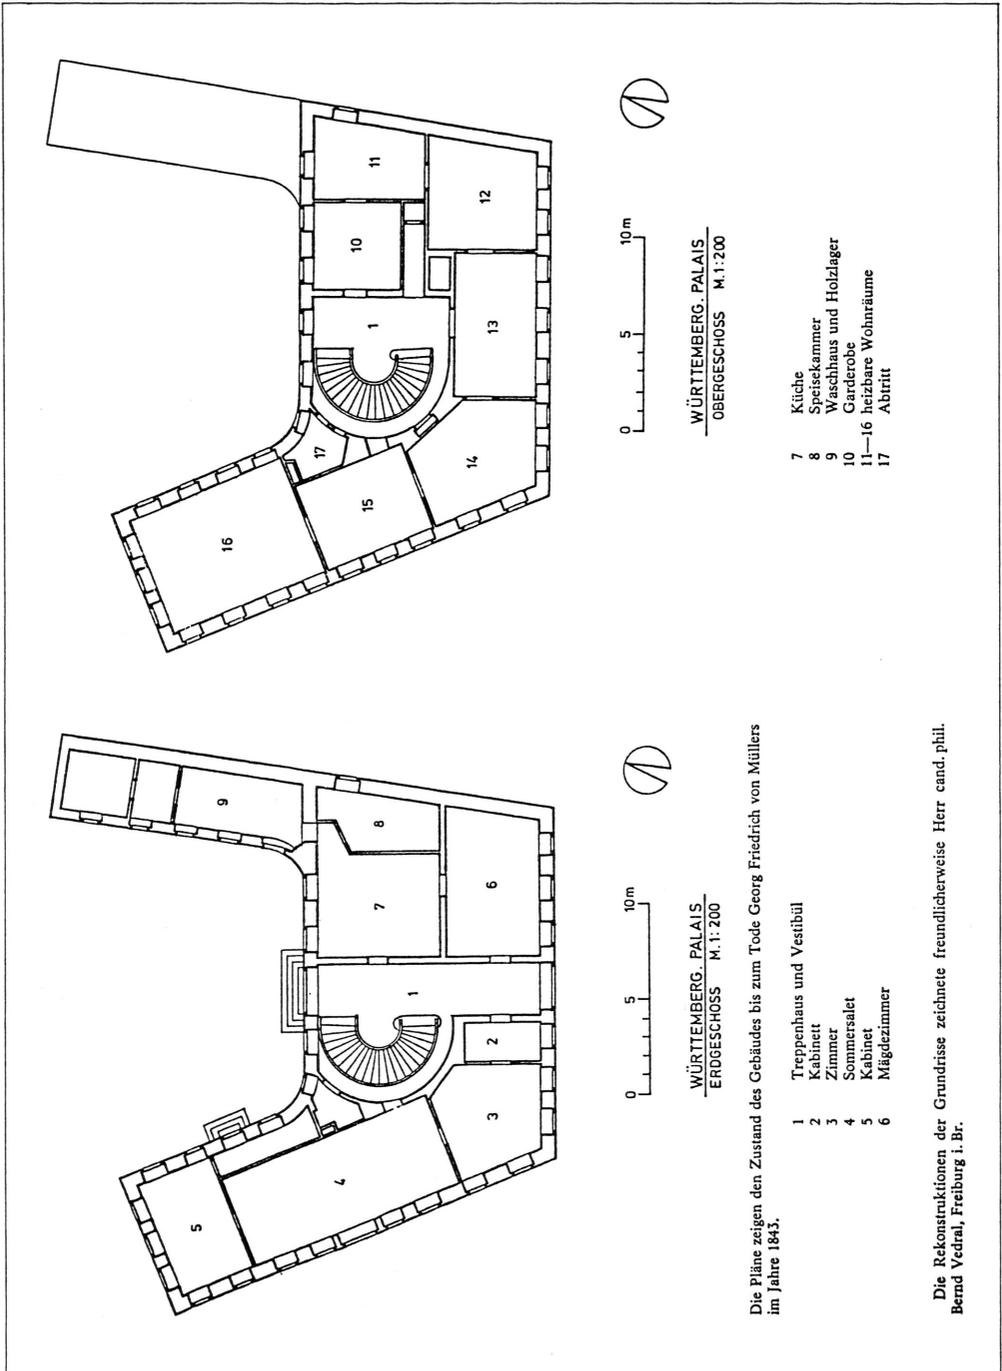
Grundrisse des Müller'schen Gartenhauses
